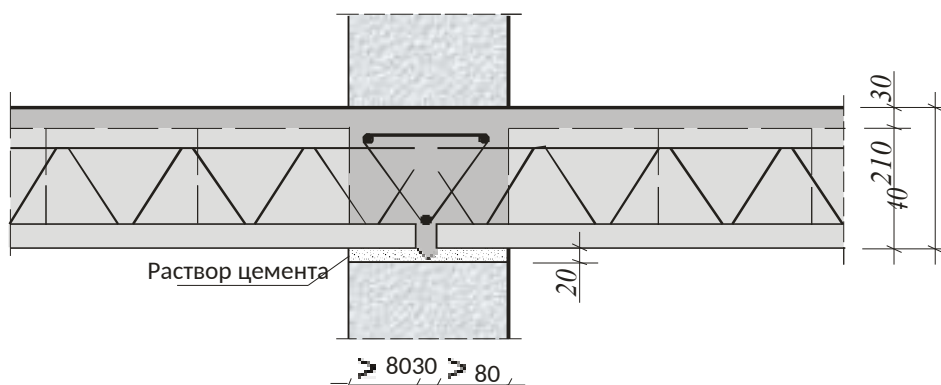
Венец, связывающий перекрытие на внутренней несущей стене.
